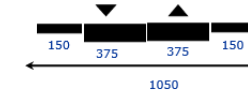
SEZIONE STRADALE TIPO C1
